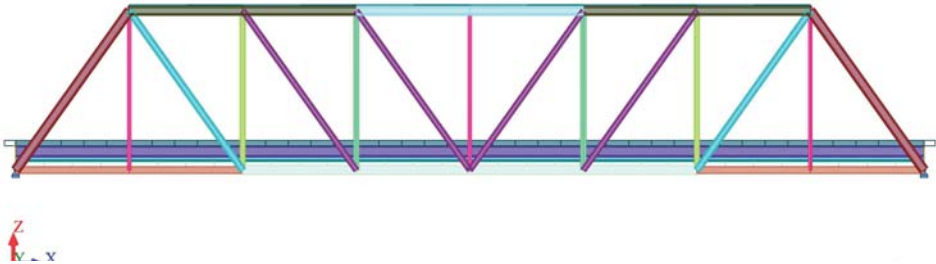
Solução B: Vista em alçado do modelo da estrutura.
